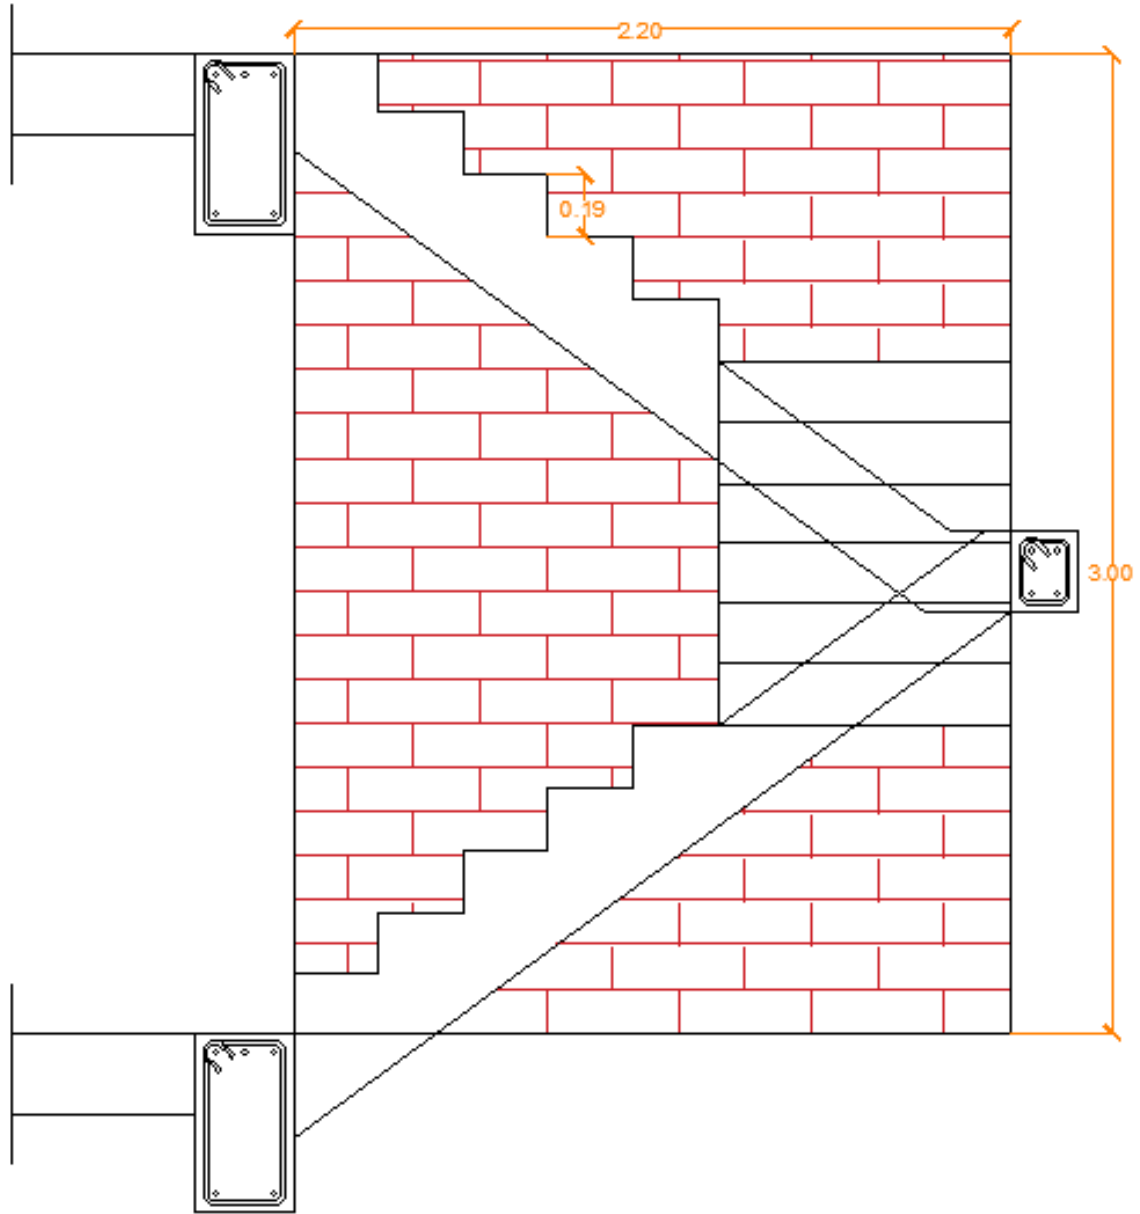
Vista en Perfil de las Escaleras Longitudinales. Fuente: Nicolás Pozo
